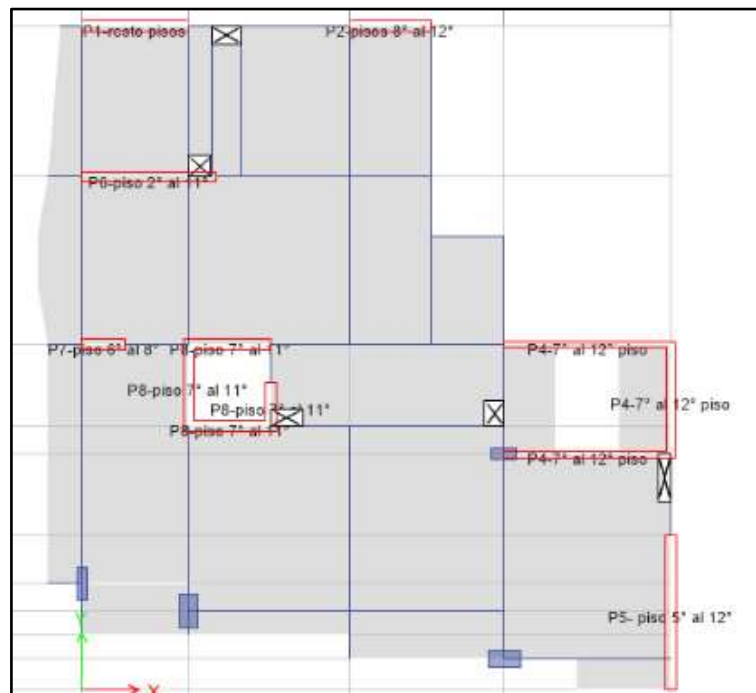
Vista en planta de M1 (piso 8° al 9°) en ETABS
